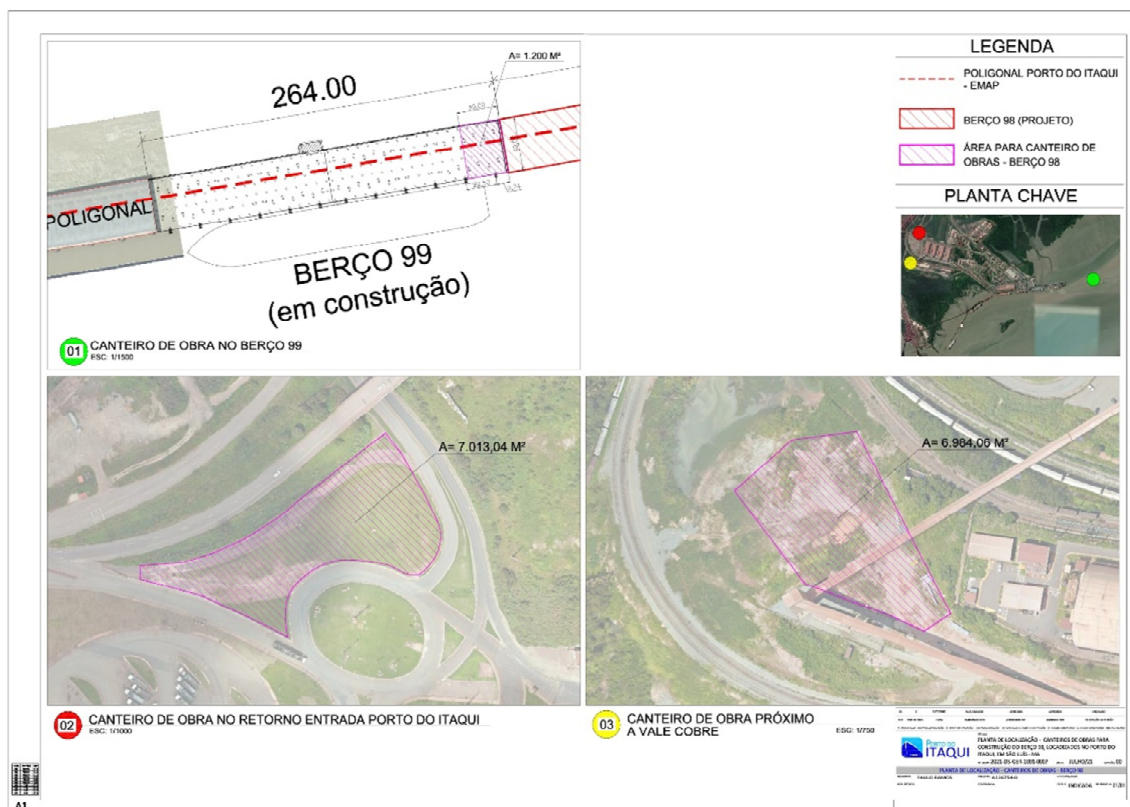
Canteiro de obras Berço 98 no Porto do Itaqui.
